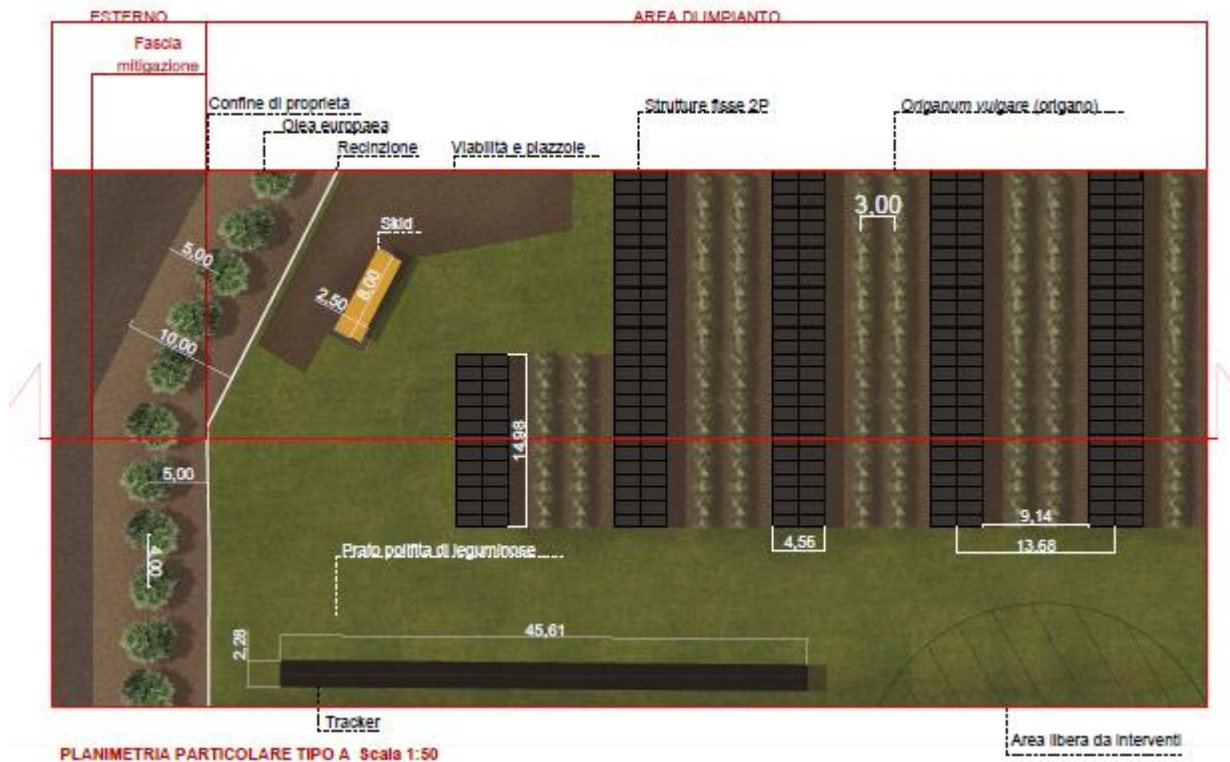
Planimetria particolare della fascia di mitigazione e dell'area di impianto.
